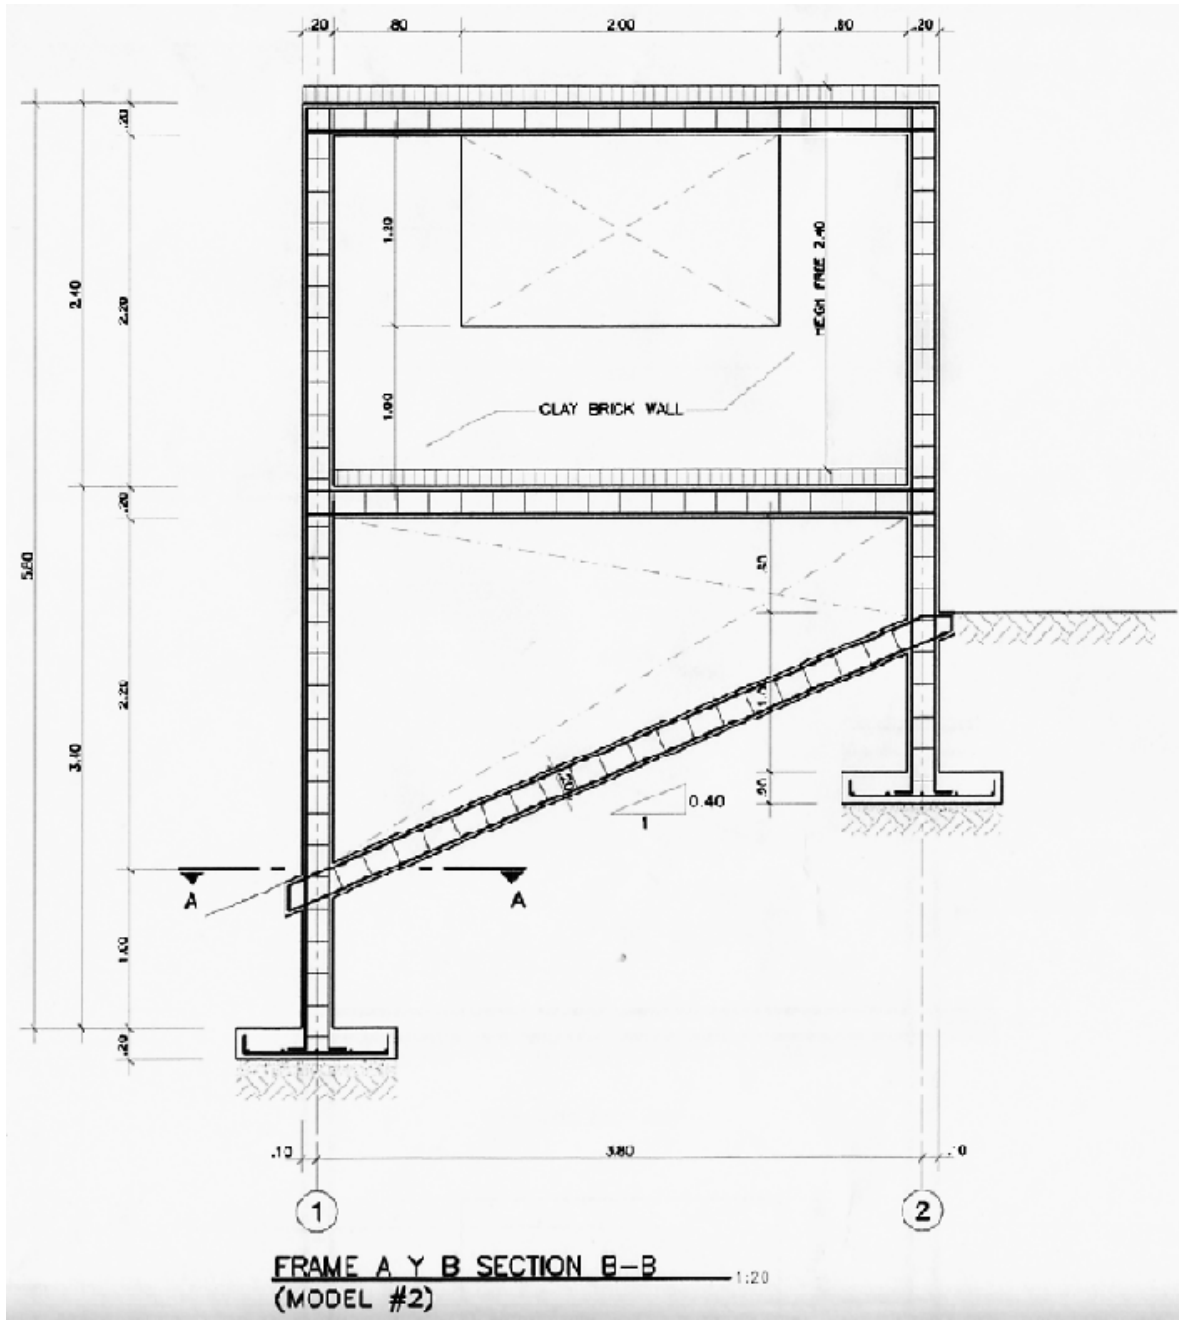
Armazón de Elevación del Modelo 2
